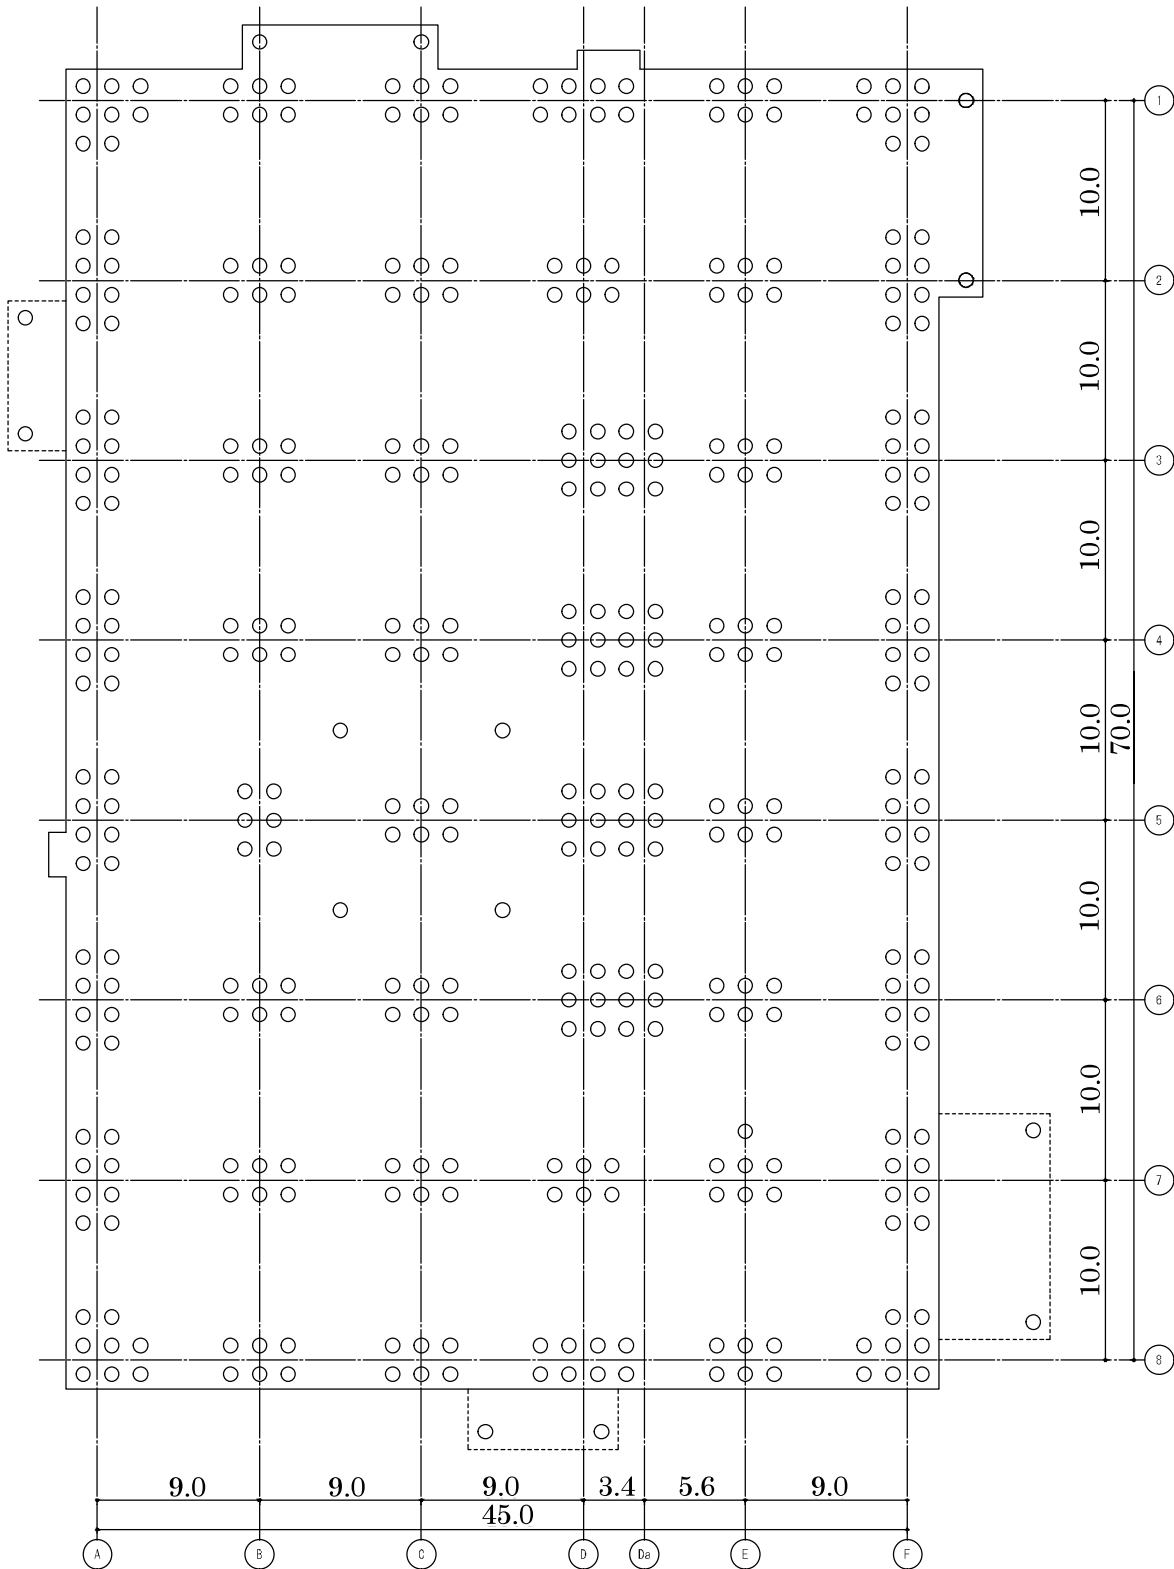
杭配置図 (G.L. -2.71~-5.17) (単位 : m)
